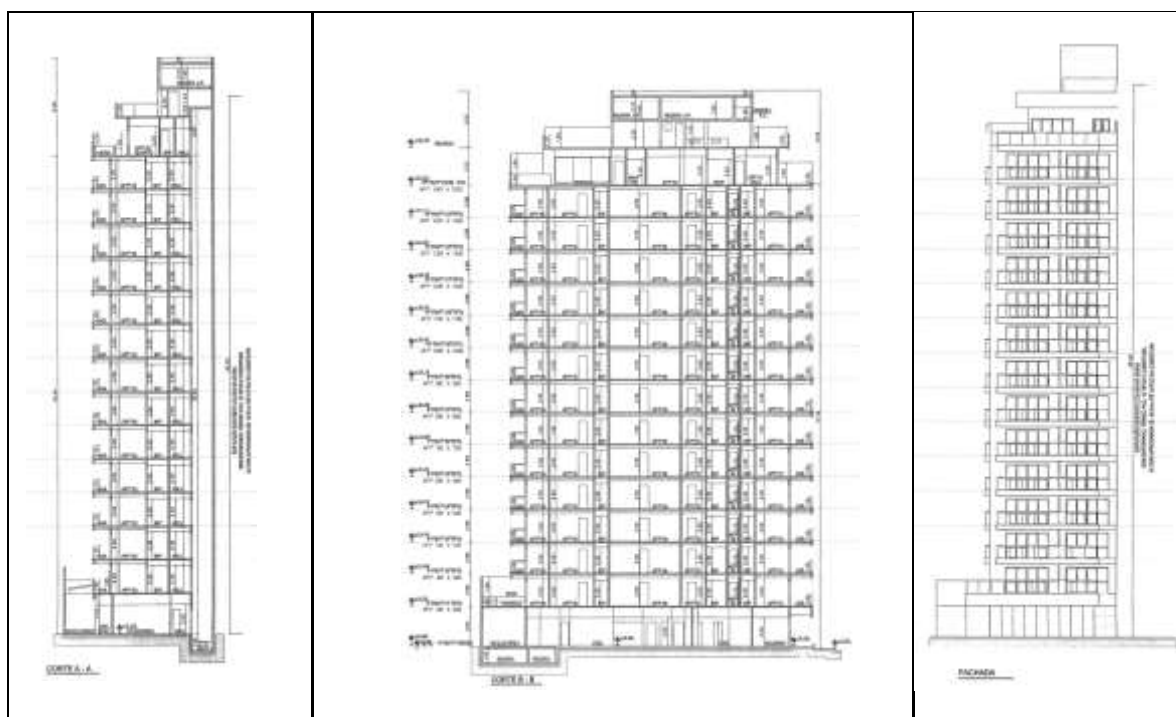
Fachada e Cortes - Fonte Projeto Legal
